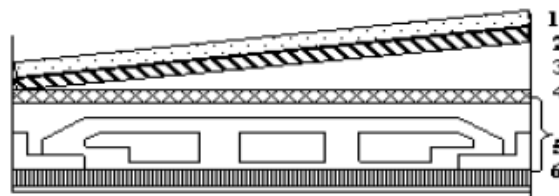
Section transversale d'un plancher (terrasse inaccessible).
